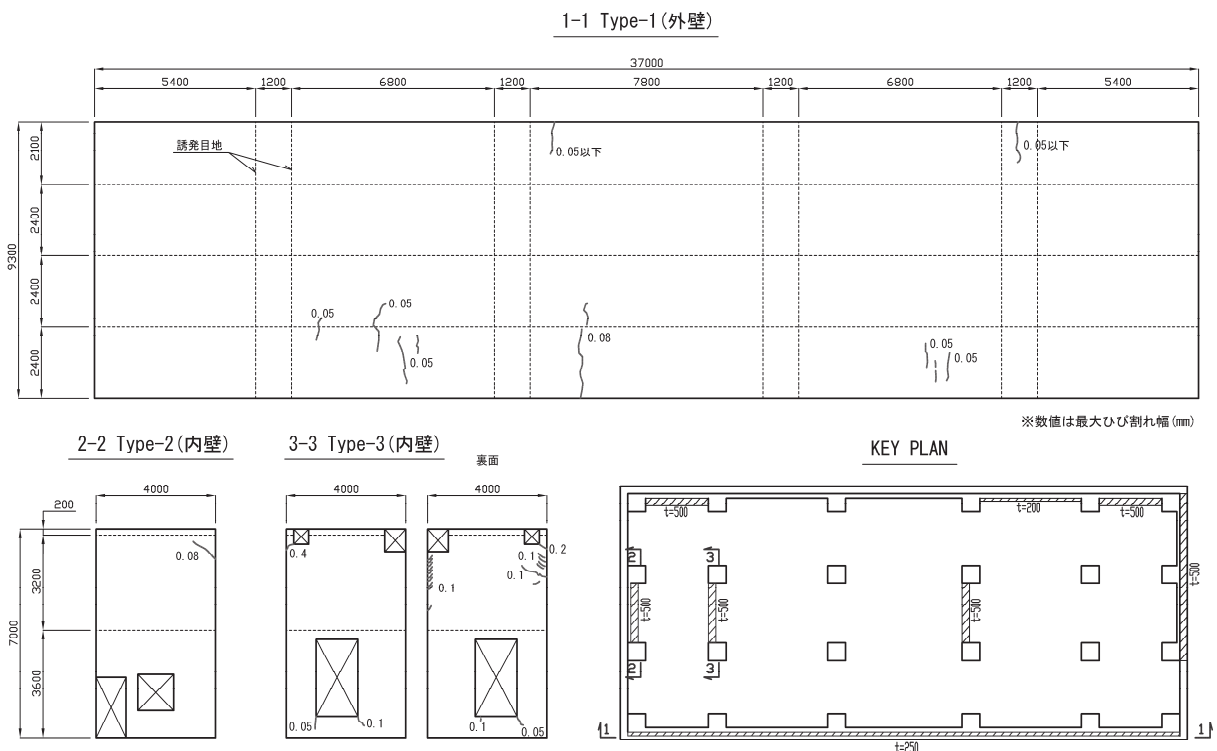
実際のひび割れ発生状況 (打設後約 1 年後)
